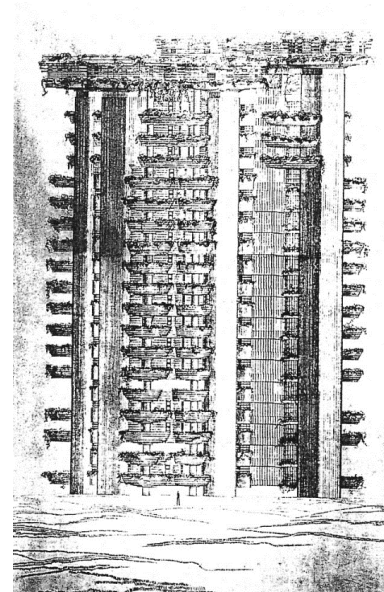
esquema de fachada con la variación de las terrazas según la vivienda
